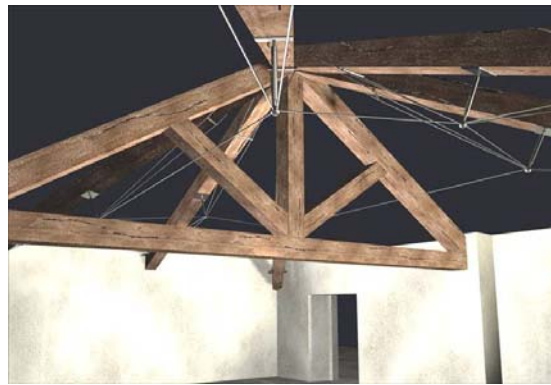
Villa Della Porta Bozzolo, Casalzuino (VA): consolidamento della capriata mediante realizzazione di struttura reticolare mista.
